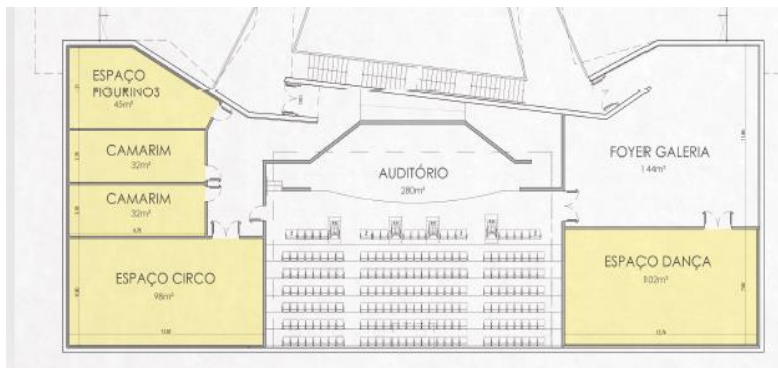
º Pavimento Anteprojeto para segunda fase de implantação
